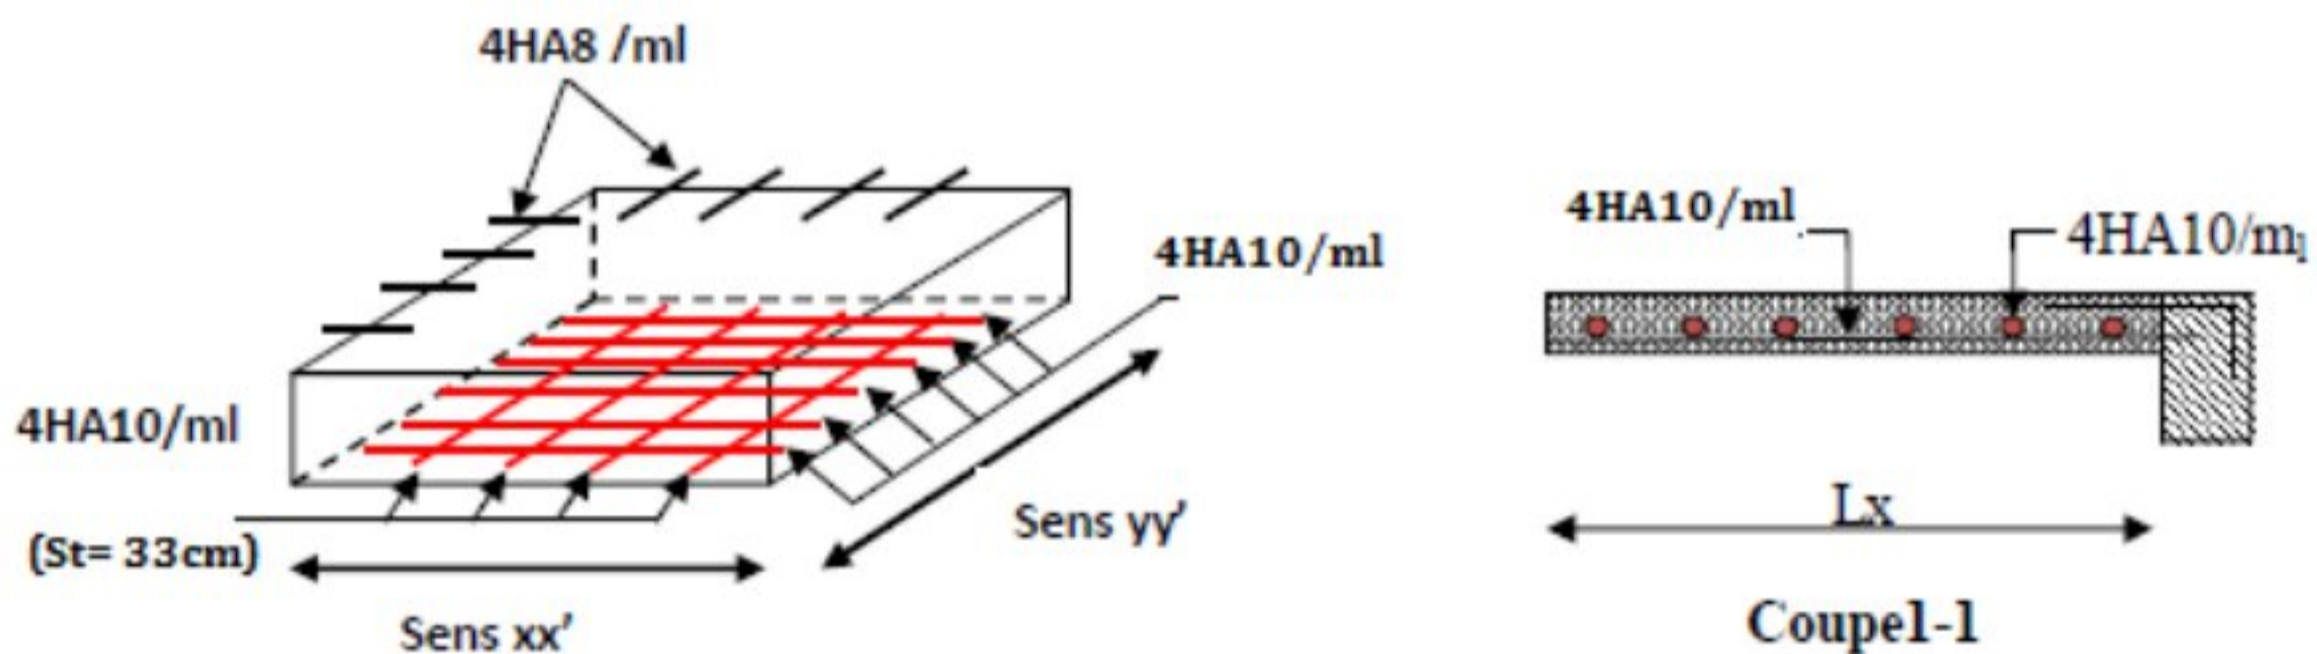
schéma de ferrailage de la dalle sur 2 appuis
